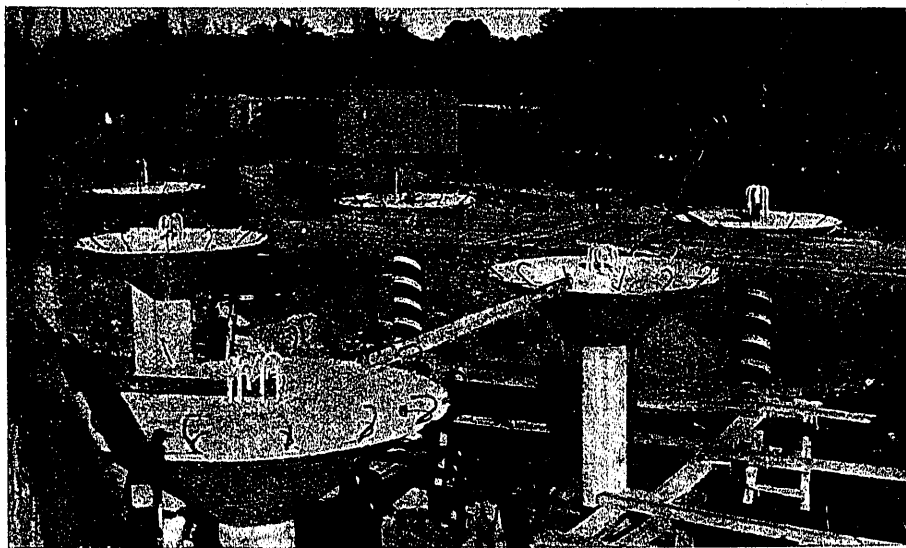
Columnas terminadas y dispuestas para empezar la construcción de los encofrados para las losas
